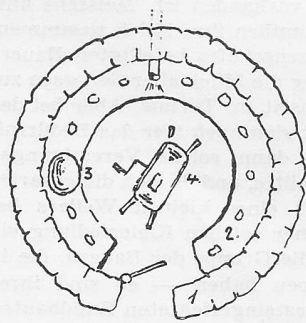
Grotto in Selva (Grundriss). Milchkeller für 12 Familien (Casarie). 1 Trockenmauer, 2 Bassin mit 12 Steinen, 3 Milchschüssel, 4 Butterfass
